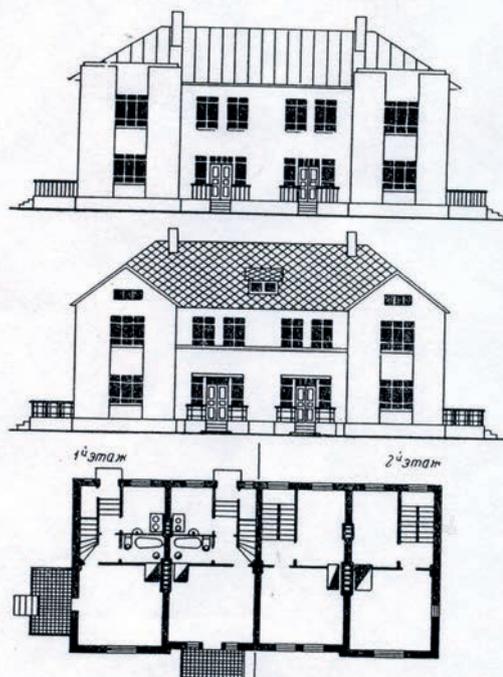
Проект 2-этажного 4-квартирного жилого дома с квартирами в 2 этажа, с вариантами фасадов. Осинстрой, 1927 г.
